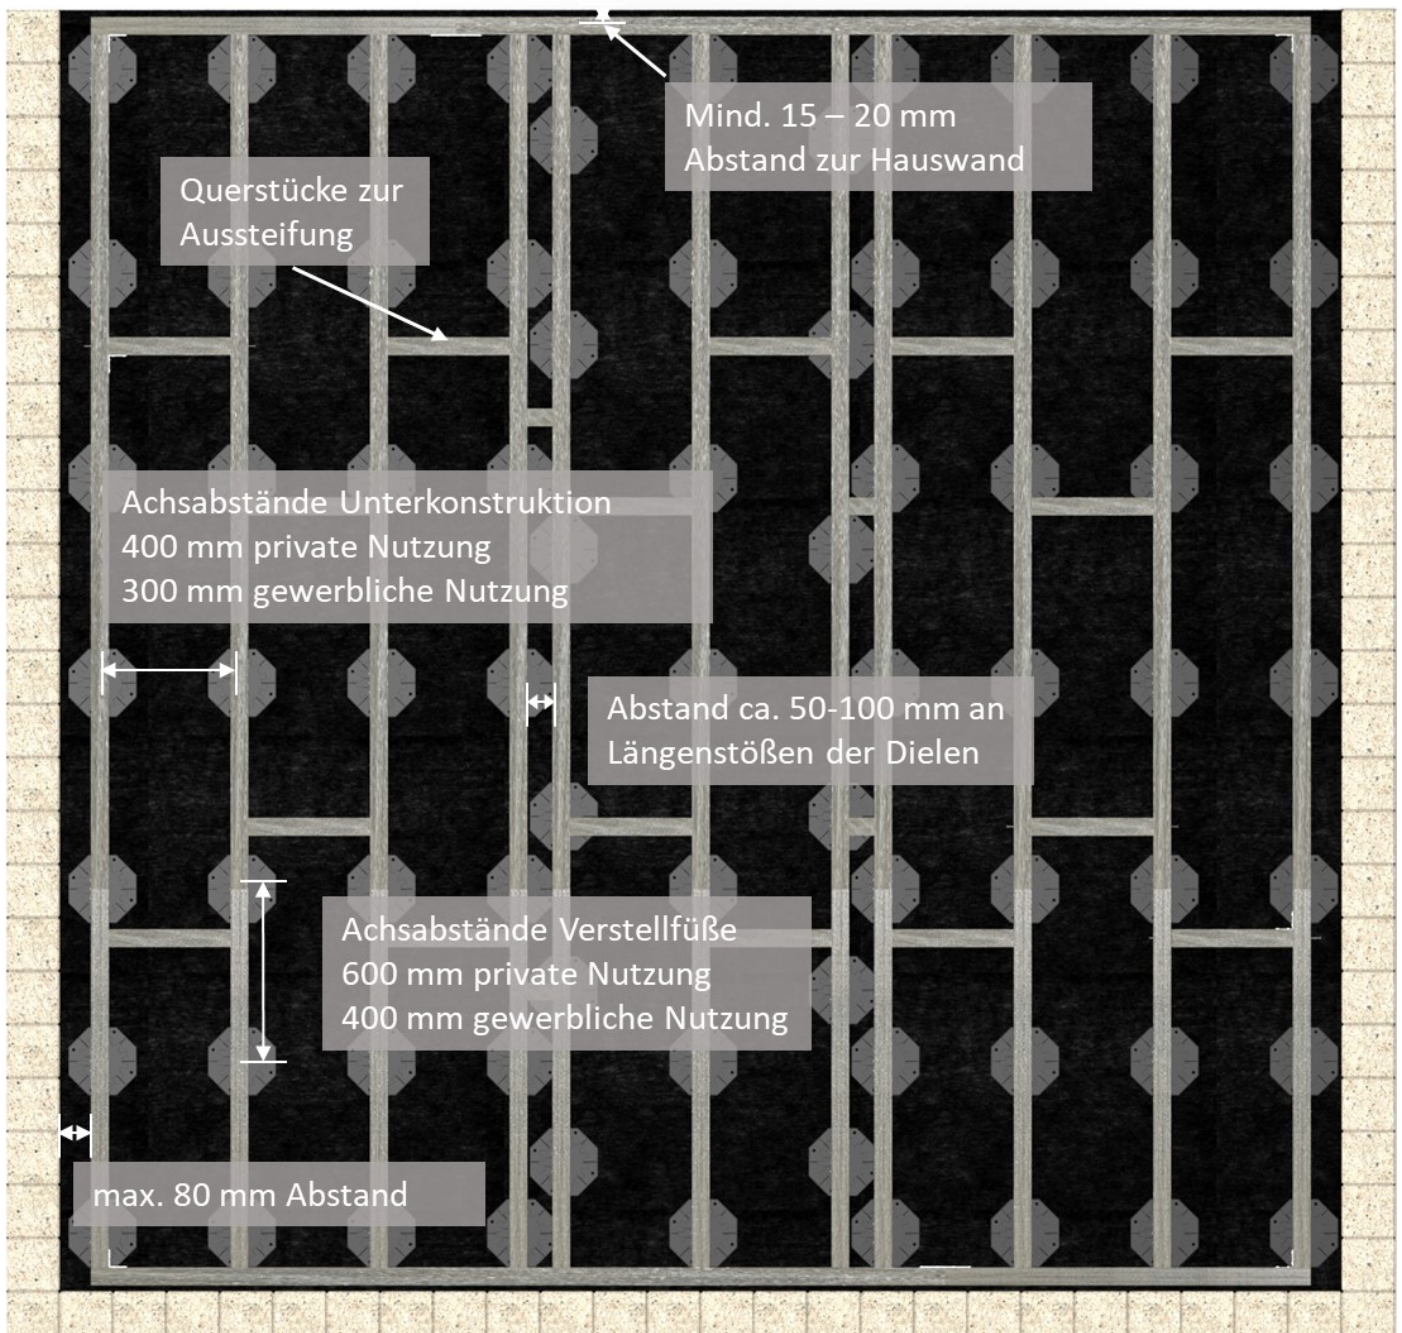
Schematische Darstellung für eine ausgesteifte Rahmenkonstruktion mit Verstellfüßen auf einer Tragschicht mit Schotter Korngröße 0-45 und einem zusätzlichen wasserdurchlässigen Unkrautvlies.
